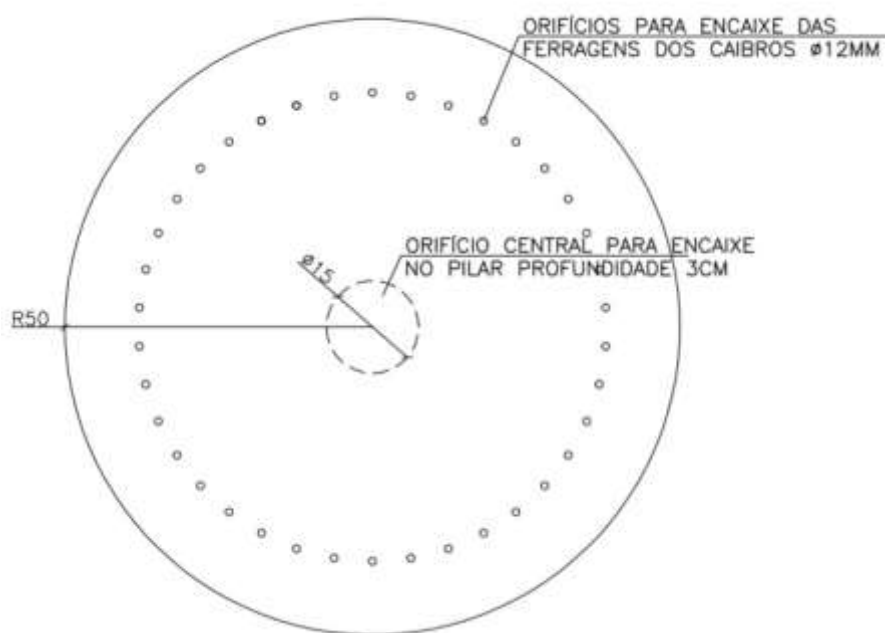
Detalhe da coroa para suporte dos caibros
